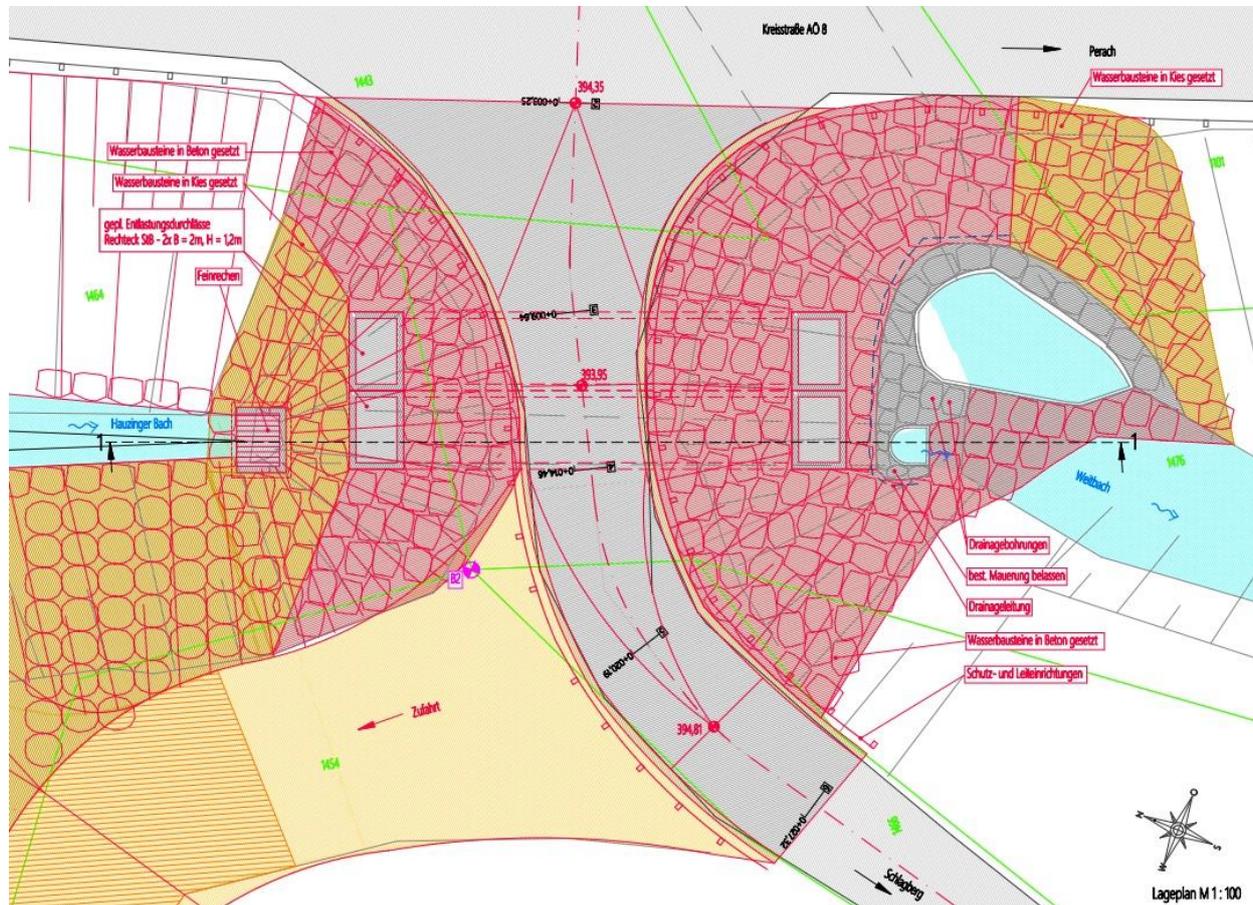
Planauszug E-DP-7.1: Lageplan Mündung Hauzinger Bach.
